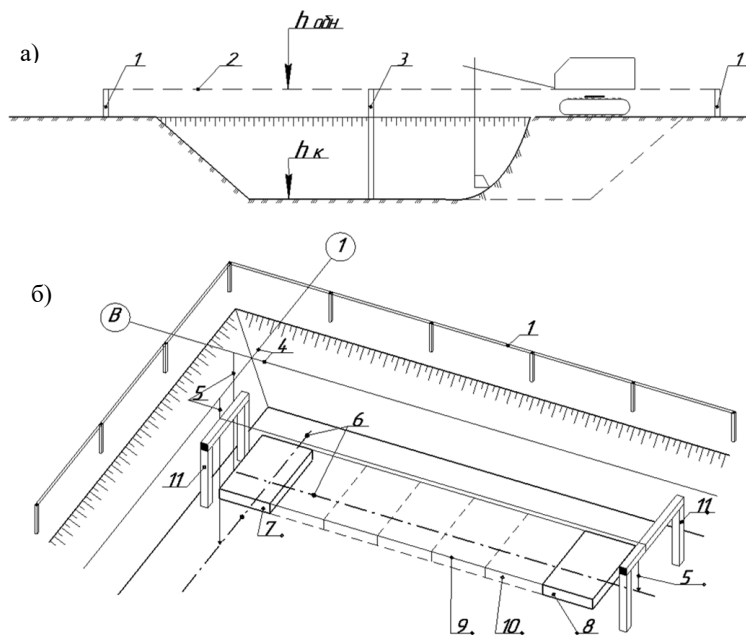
Обноска и ее применение: *a* – для контроля глубины копания котлована; *б* – для монтажа фундаментных блоков; 1 – обноска; 2 – линия визирания; 3 – ходовая визирка; 4 – проволочные оси; 5 – отвесы; 6 – разметочные колышки; 7 – угловой блок; 8 – маячный блок; 9 – шнур-причалка; 10 – промежуточные блоки; 11 – скамейки
